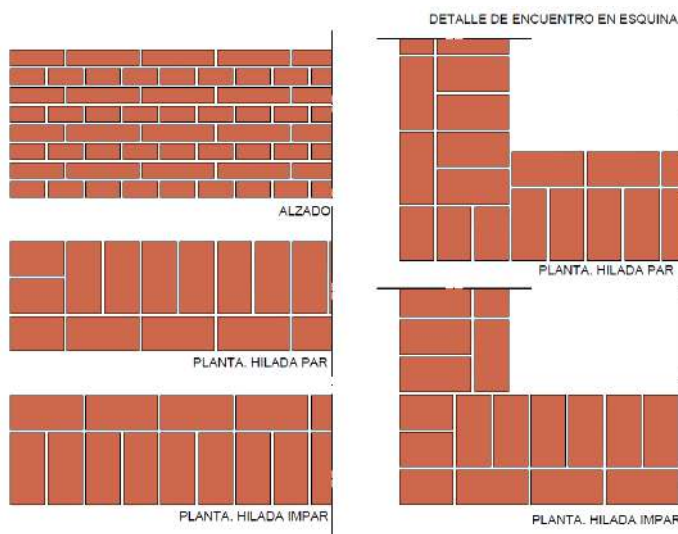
Detalle muro de ladrillo. 2016. Fuente Propia
